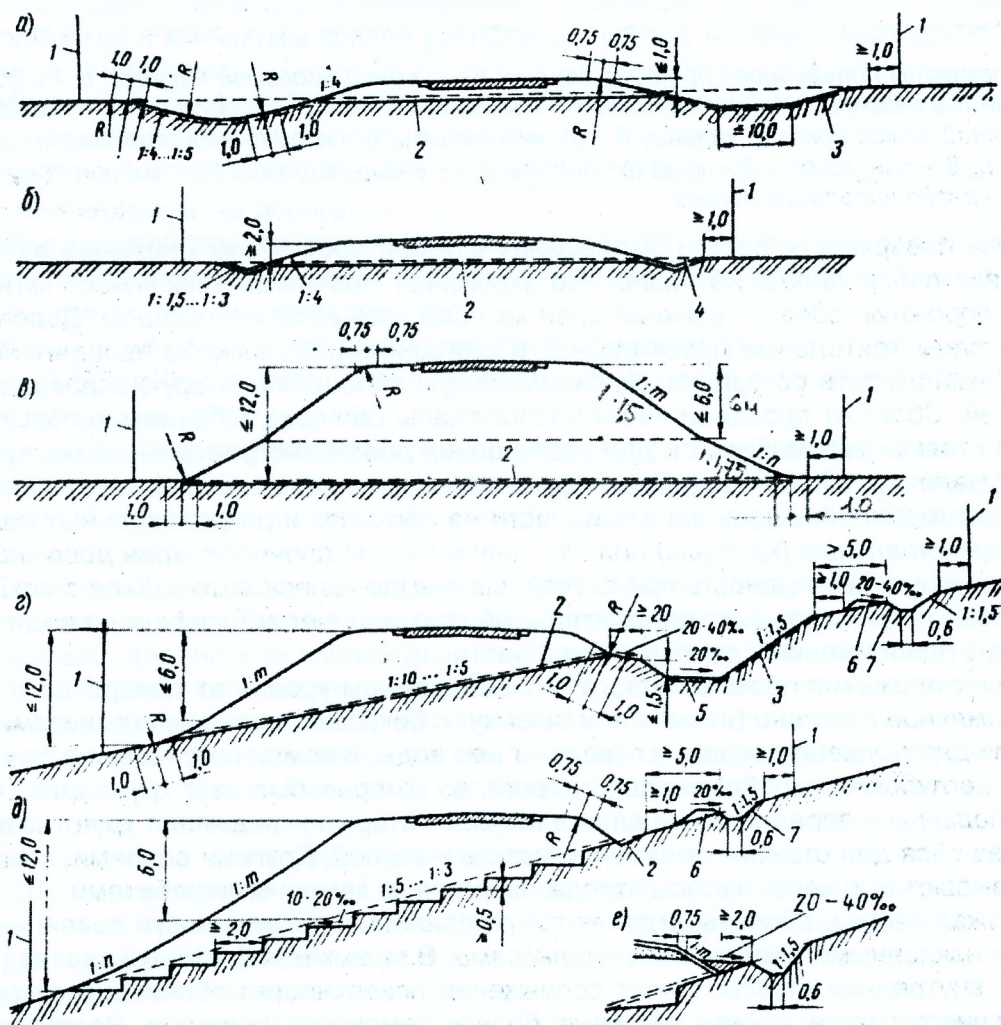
Поперечные профили земляного полотна в насыпях: а – обтекаемый поперечный профиль с кюветом-резервом при высоте менее 1 м; б – необтекаемый поперечный профиль при высоте до 2 м; в – при высоте до 12 м; г – на косогоре с уклоном менее 1:1,5 до 1:3 с резервом; д – на косогоре крутизной от 1:5 до 1:3; е – деталь сопряжения верхового откоса насыпи с поверхностью грунта при отсутствии нагорной канавы; 1 – граница полосы отвода; 2 – сминаемый слой растительного грунта; 3 – слой растительного грунта, укладываемого на откосах; 4 – треугольная канава глубиной по расчету, но не менее 0,3 м; 5 – резерв размером в зависимости от необходимого количества грунта; 6 – банкет высотой не более 0,6 м; 7 – нагорная канава глубиной по расчету, но не менее 0,6 м
